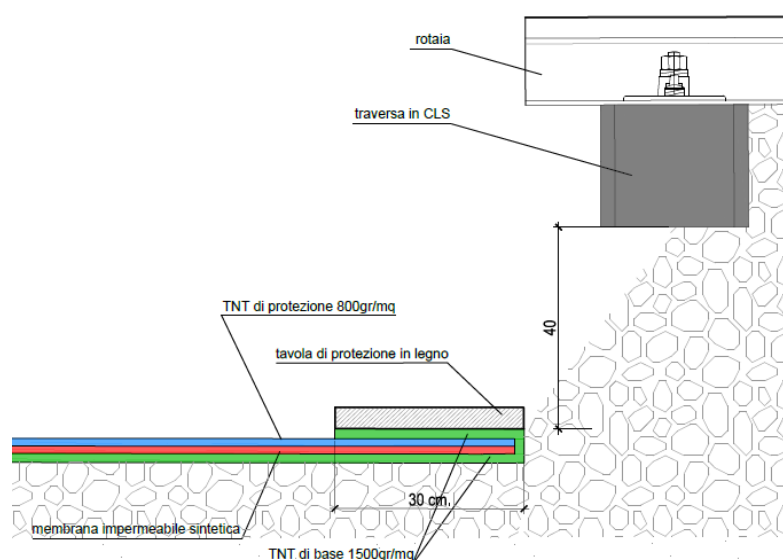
a - Protezione della giunzione trasversale
